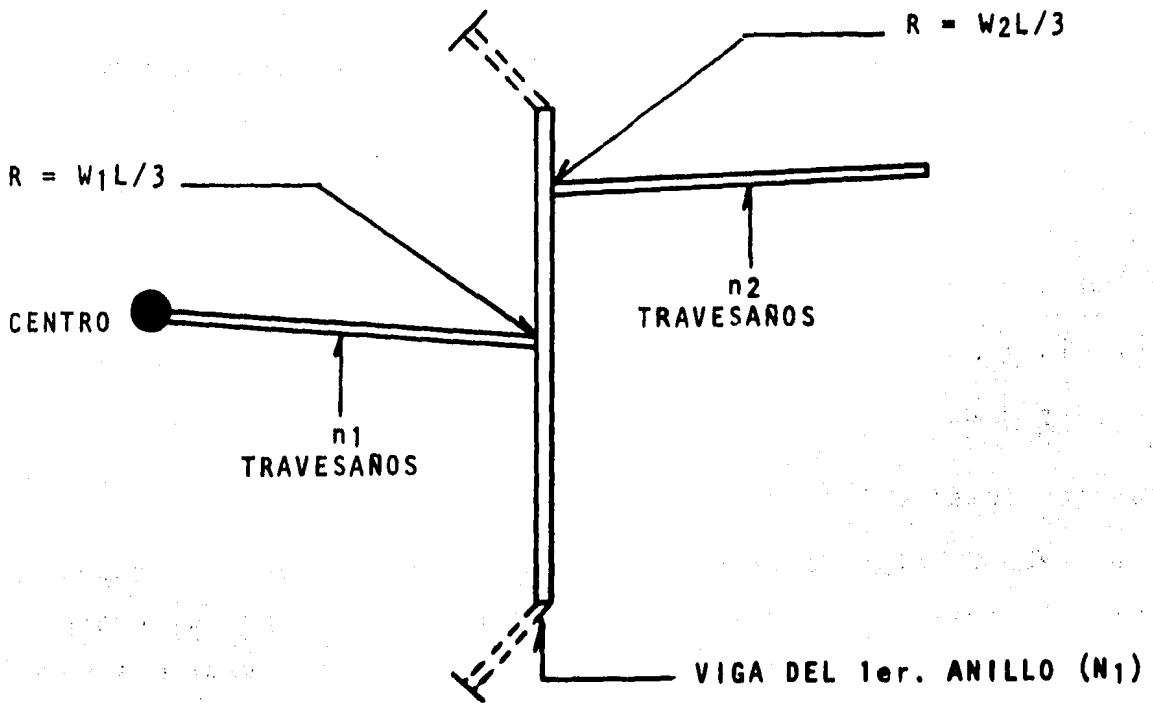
DISPOSICION DE LAS VIGAS DEL PRIMER POLIGONO.
